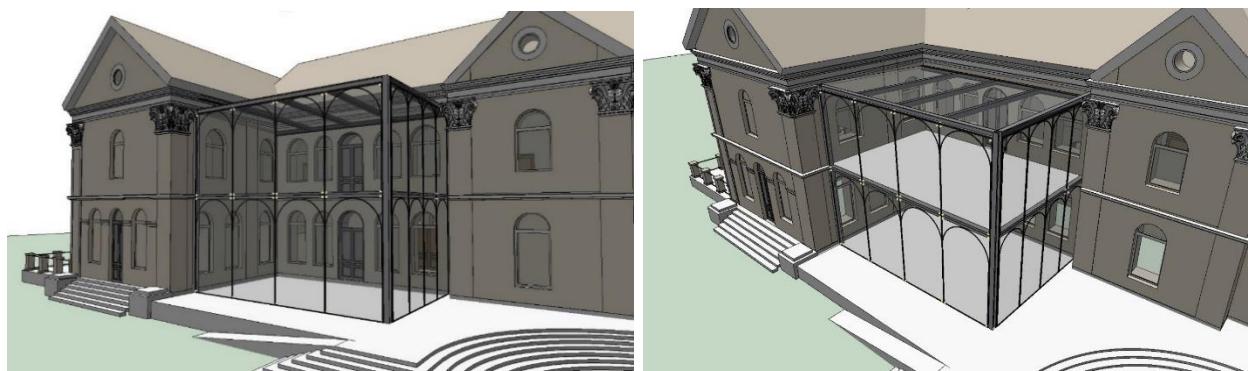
Вид будівлі з проектованим скляним входом.
